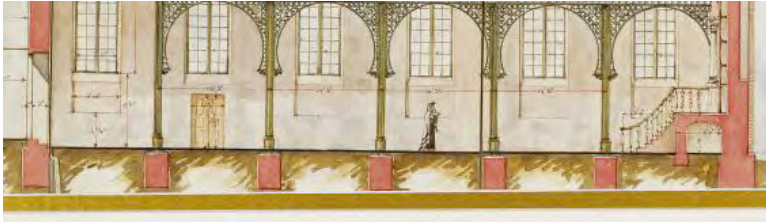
Planmaterial Adolf Zeligson Ausschnitt Längsschnitt; der Schnitt stimmt mit dem Grundriss überein
